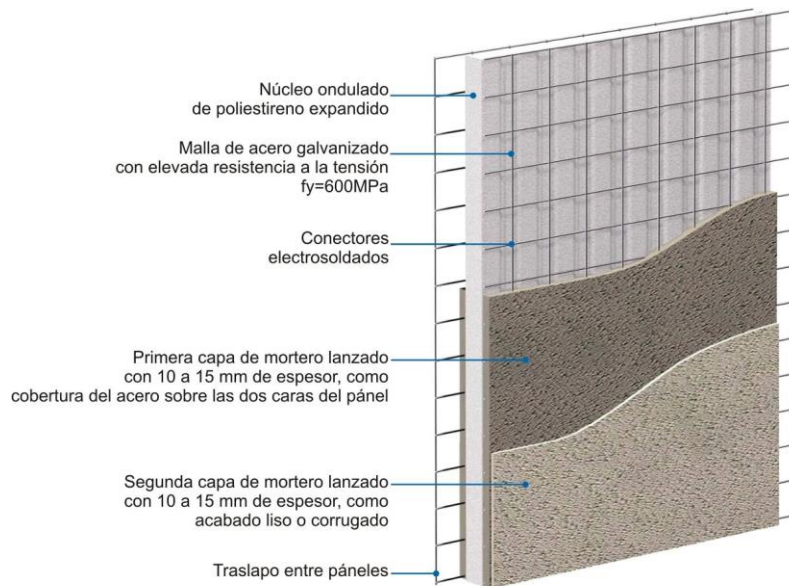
Detalle muro dura panel Fuente <https://www.obracivilcolombia.com/durapanel/14-durapanel.html>
